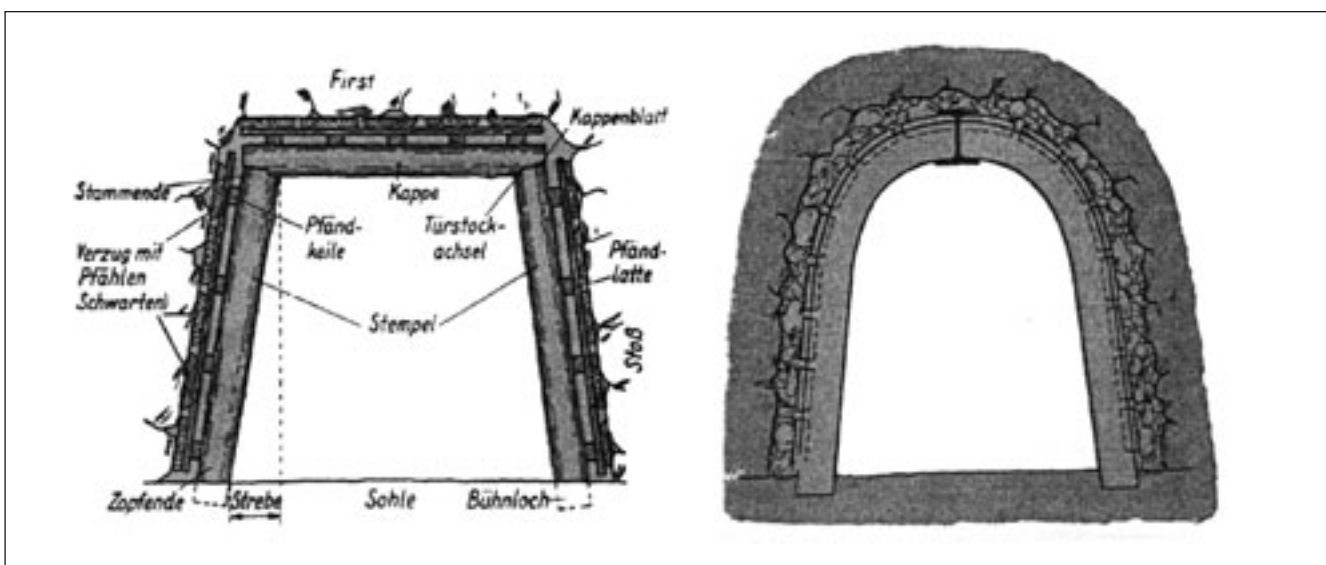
Holz- und Stahlbetonausbau (Deutscher Türstock) und Ausbau mit Stahlbeton
